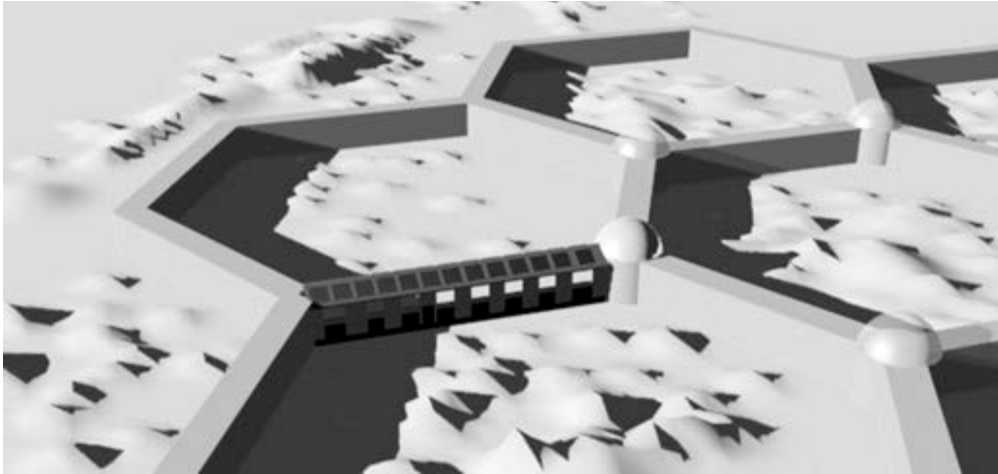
Реалистичный фрагмент одного корпуса «Арктического улья»
